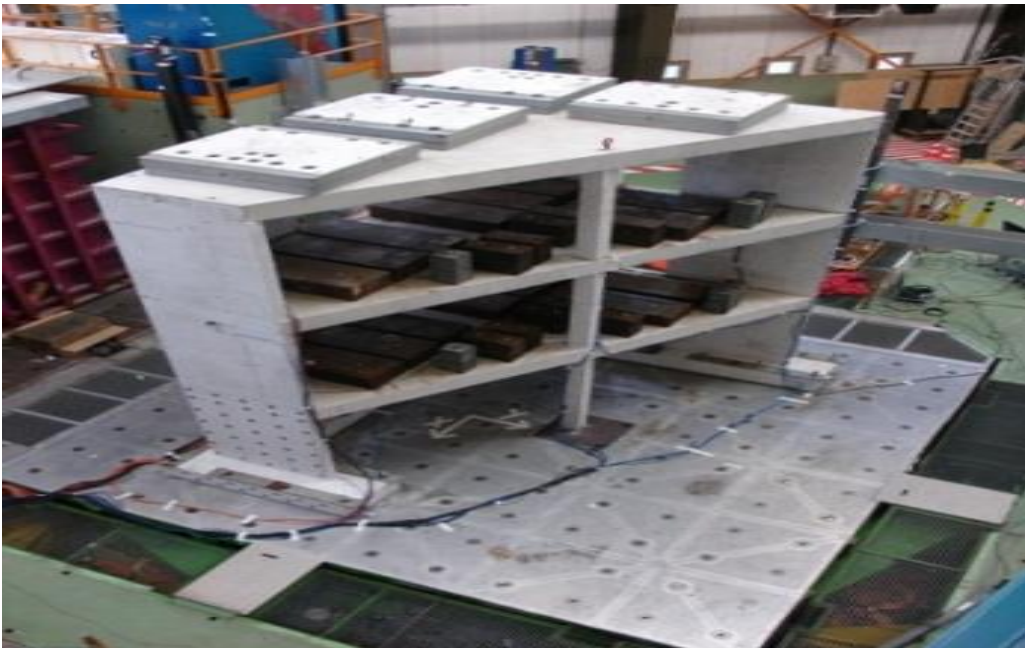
Essai sur maquette GC-table Azalée CEA/Sacl [10]
